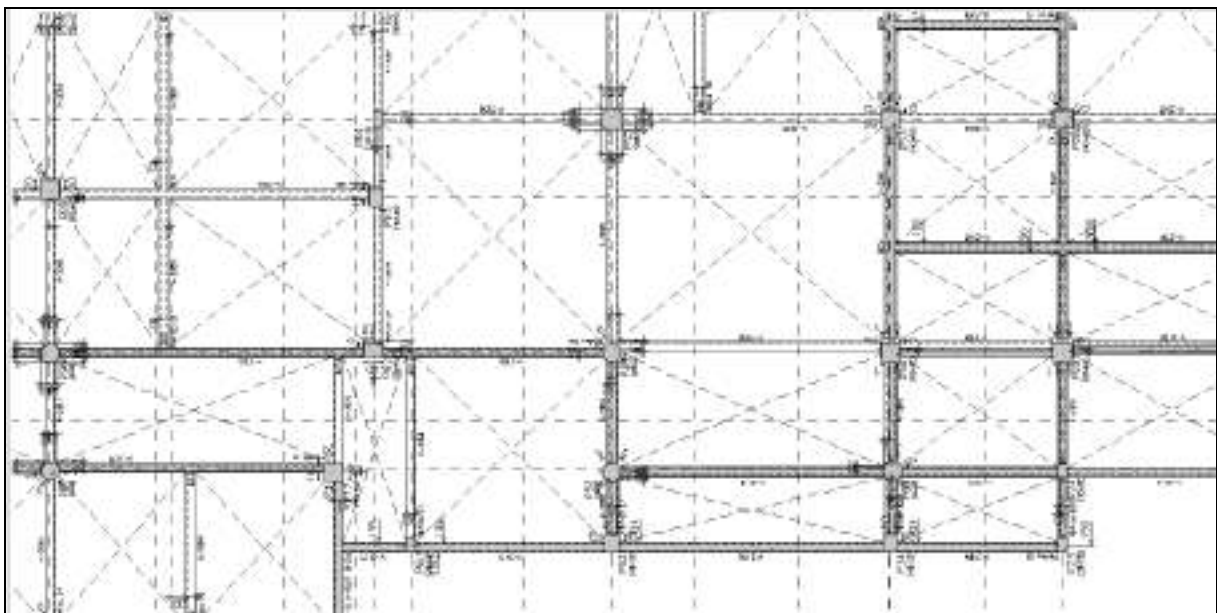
Revit - Elaboración de planos de vigas de cimentación
